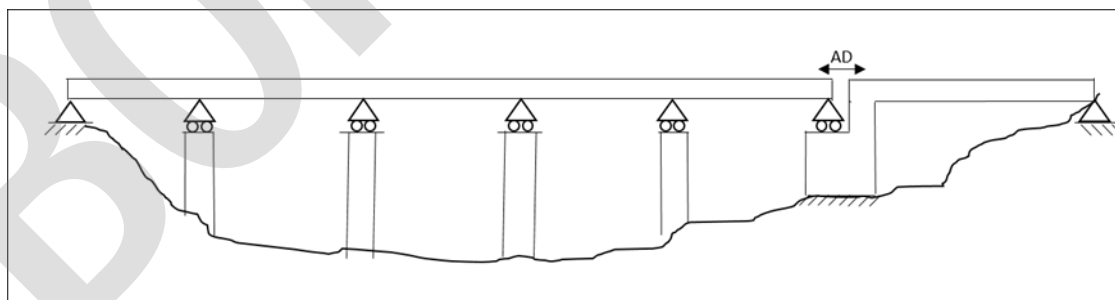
Estribo-Pórtico en viaductos y disposición del aparato de dilatación sobre la junta.
